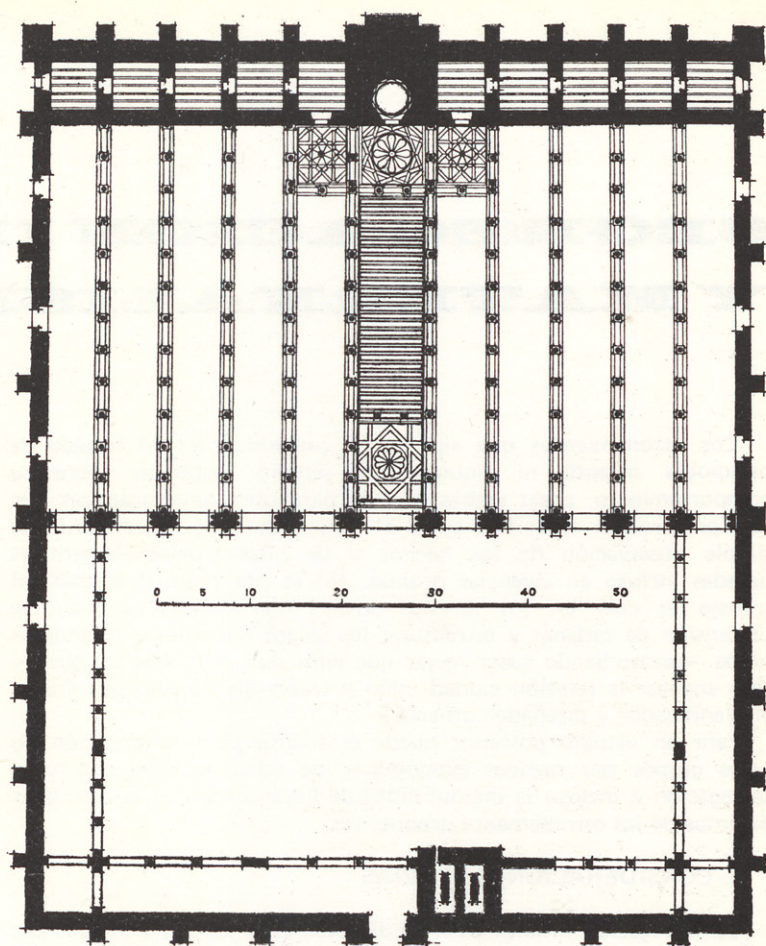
Mezquita de al-Hakam II, aislada del resto de la construcción. Planta hipotética. (CHUECA.)
